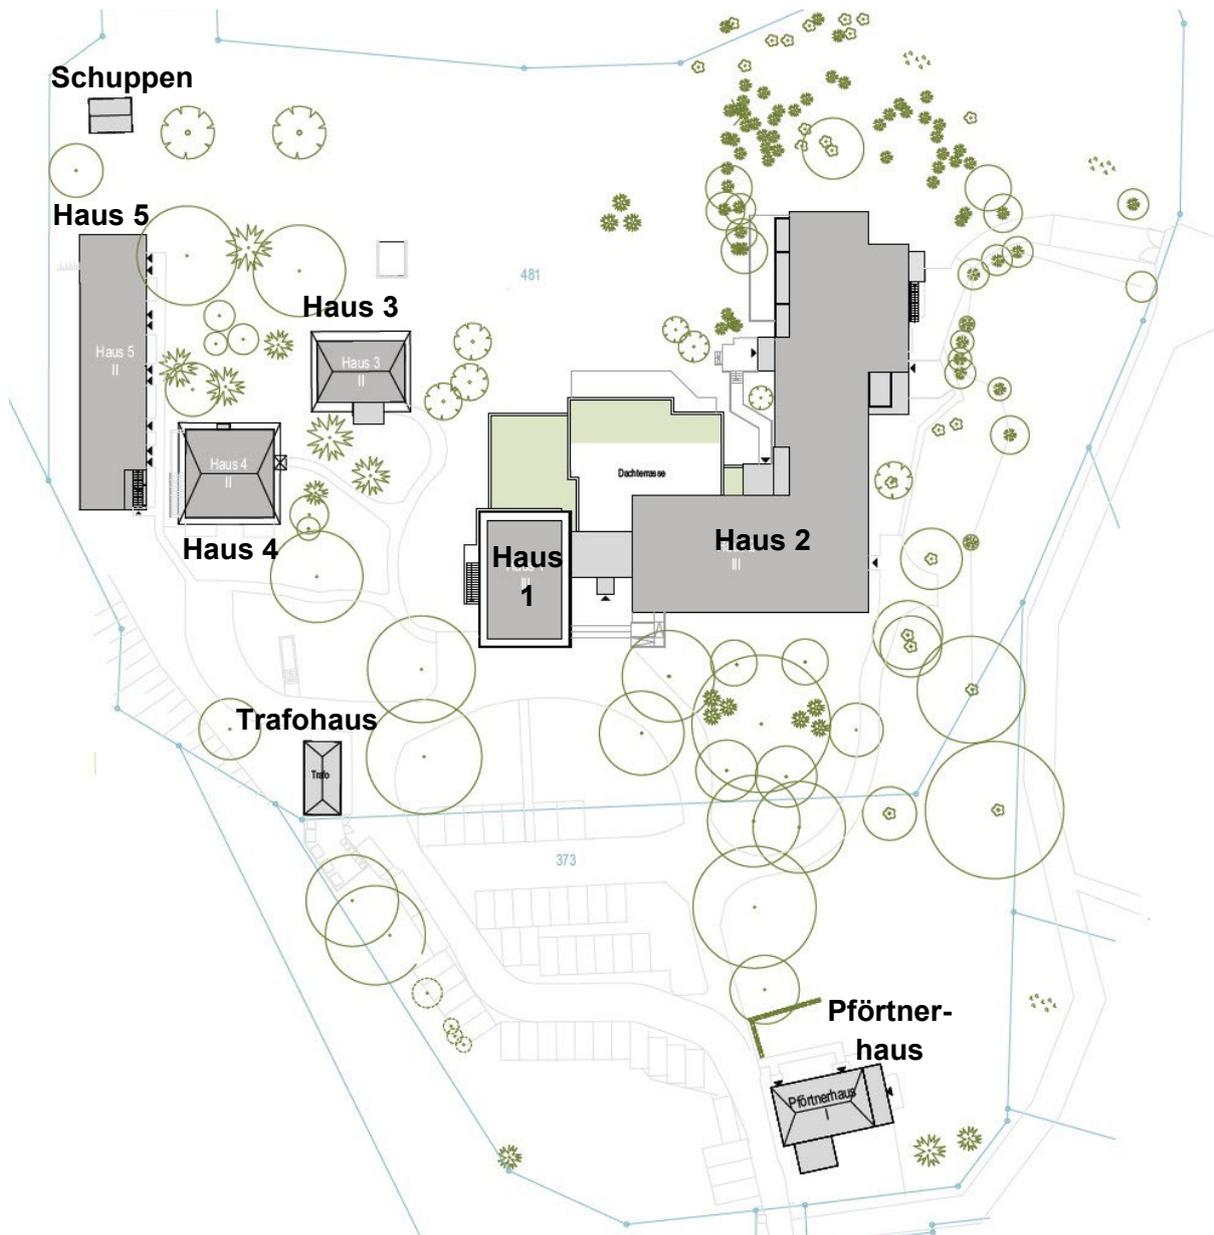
Lageplan mit Bezeichnung der Haupt- und Nebengebäude
